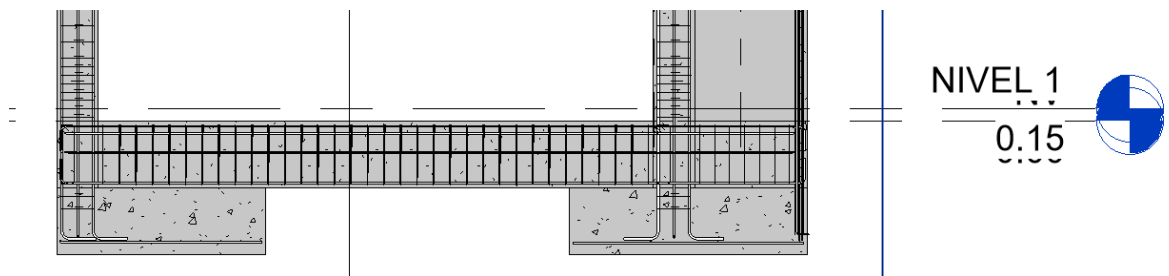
Vista Corte de distribución de acero en Viga de Cimentación en otra dirección (Fuente: Elaboración Propia).
